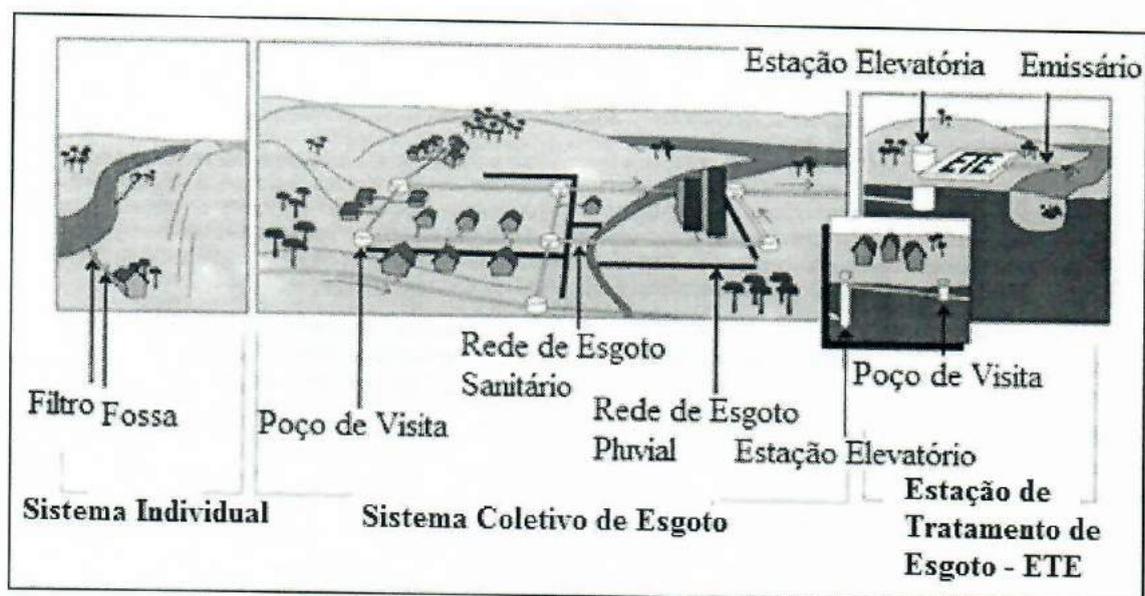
Sistema adequado de tratamento de esgoto sanitário.
